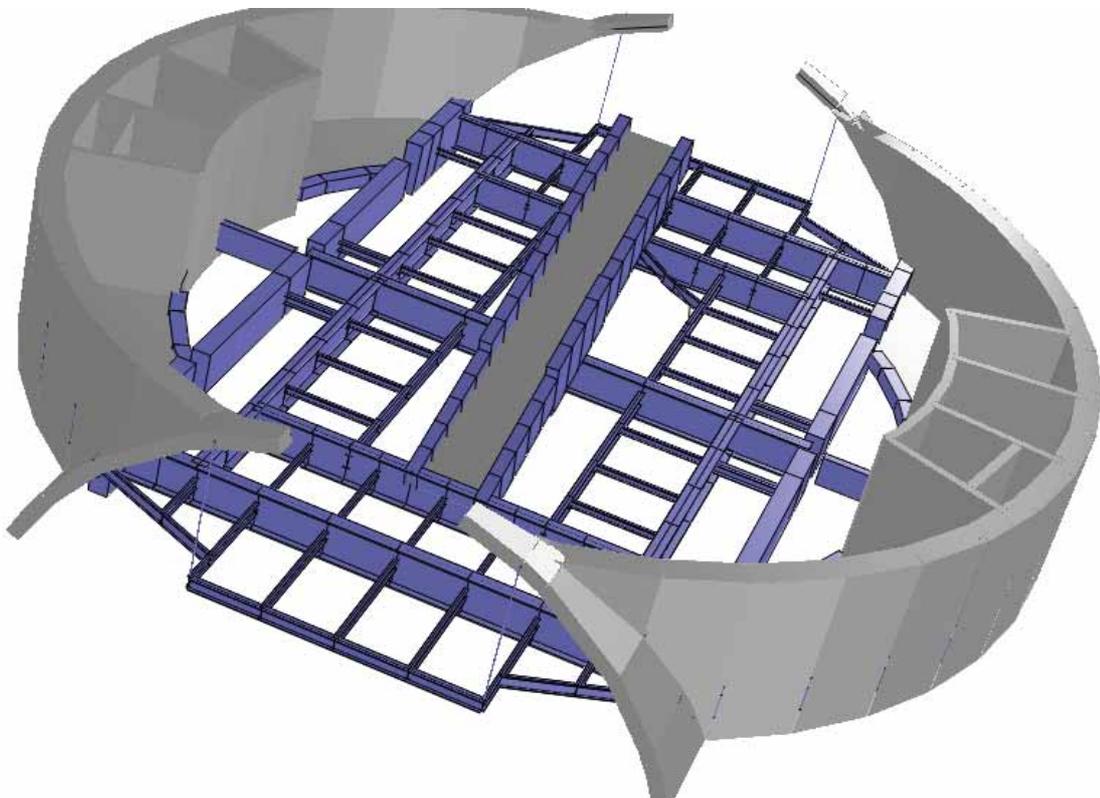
Vista da Seção Transversal do Poço de Acesso
